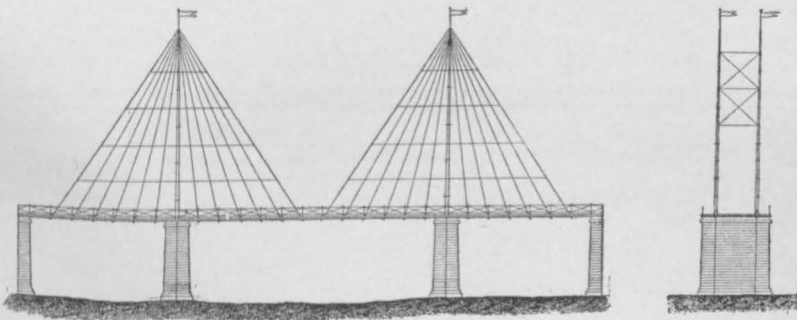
Bauart POYET (nach NAVIER). 1821.
